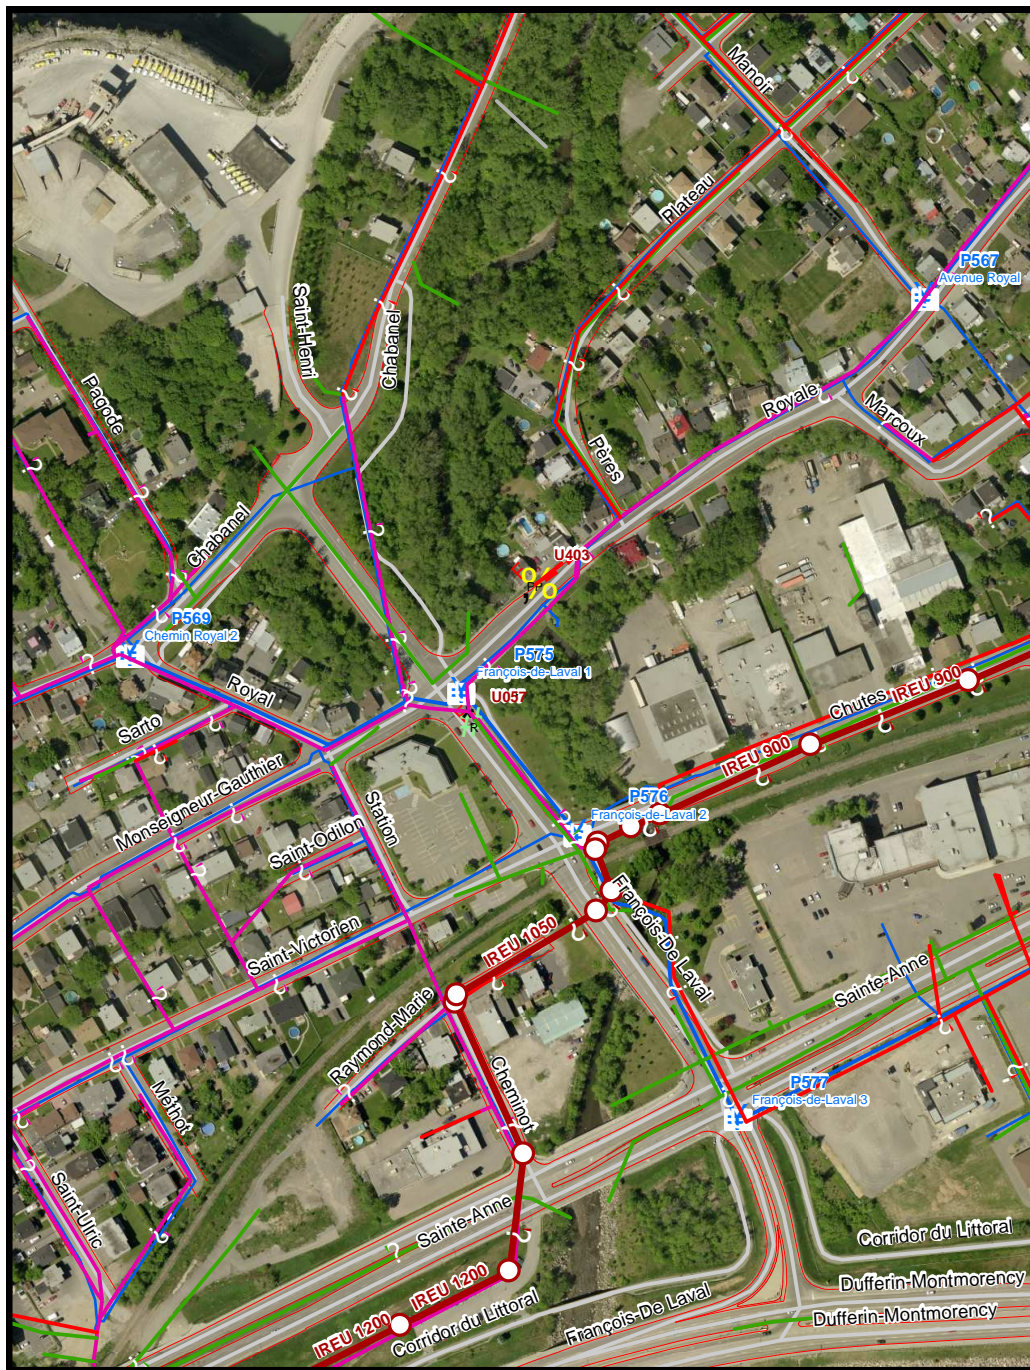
Plan du réseau d'infrastructures souterraines dans le secteur du parc Chabanel (CfEt-26).
